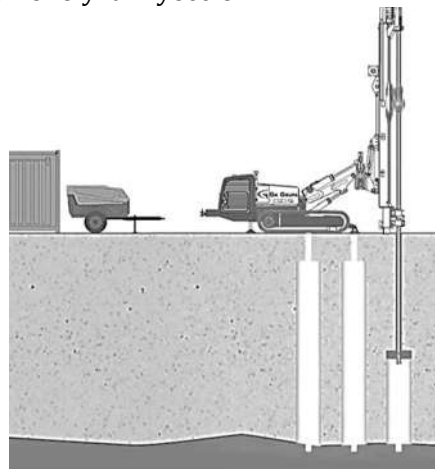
Construcción de columnas jet-grouting (González de Vallejo, 2004).
